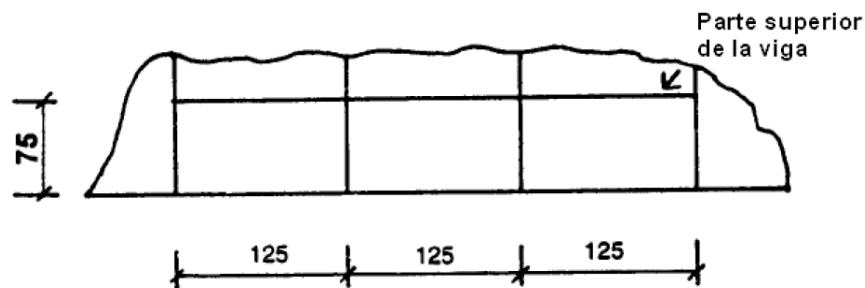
Corte y orientación de vigas obtenidas de panel de hormigón proyectado (EFNARC, 1993)
